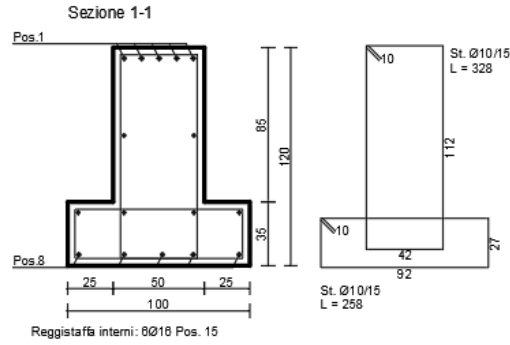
Tipologico ferri di armatura travi rovesce di fondazione
